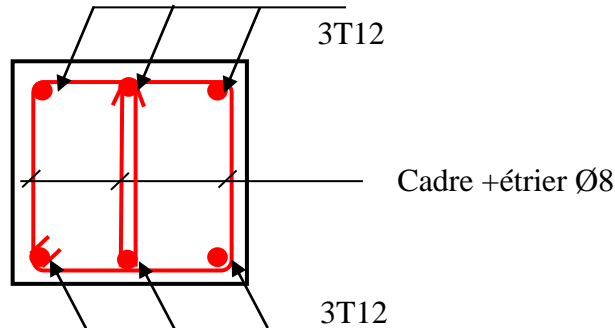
Schéma de ferrailage de la poutre de chaînage
